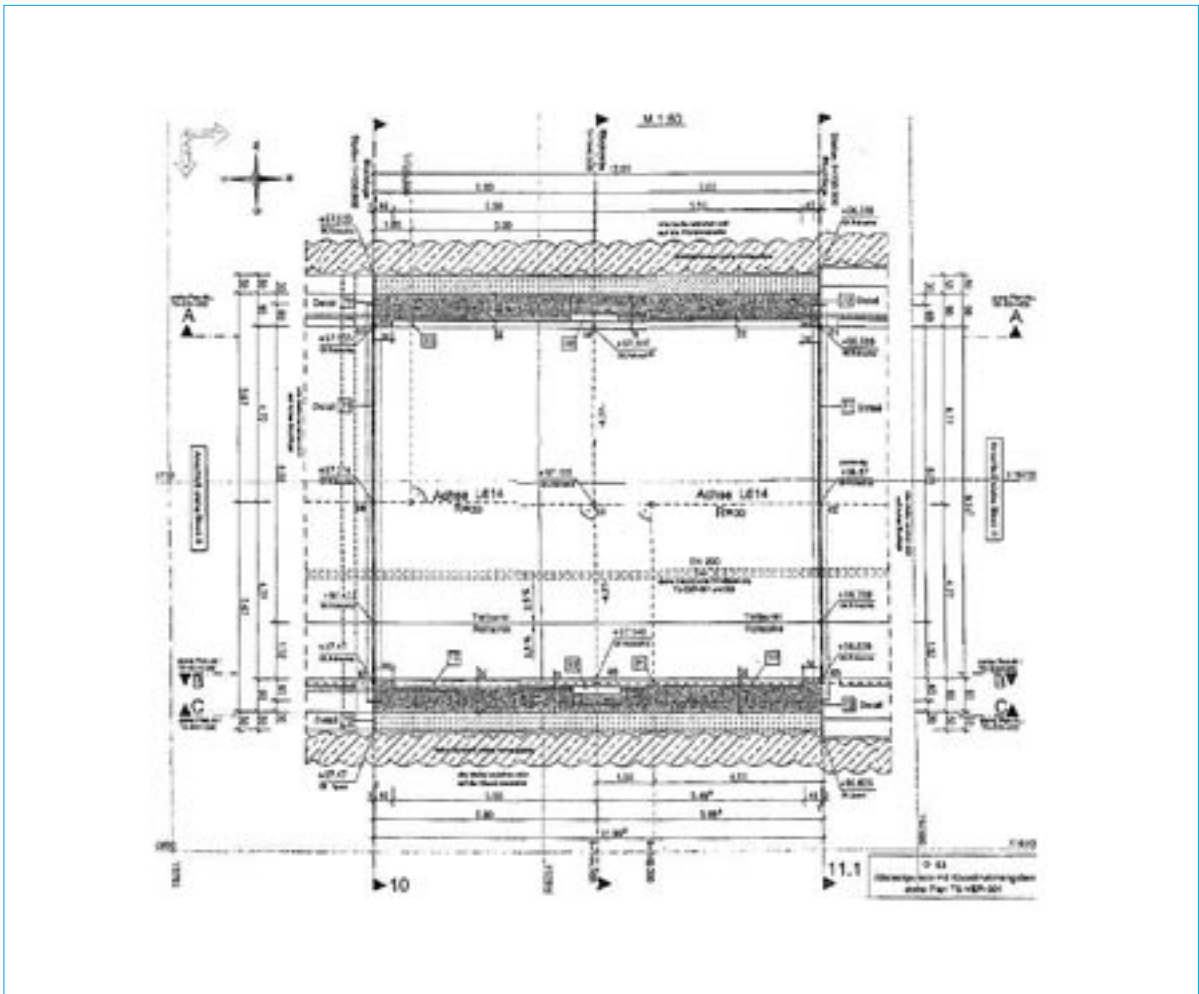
Grundriss des Trogbauwerks, Block 10
